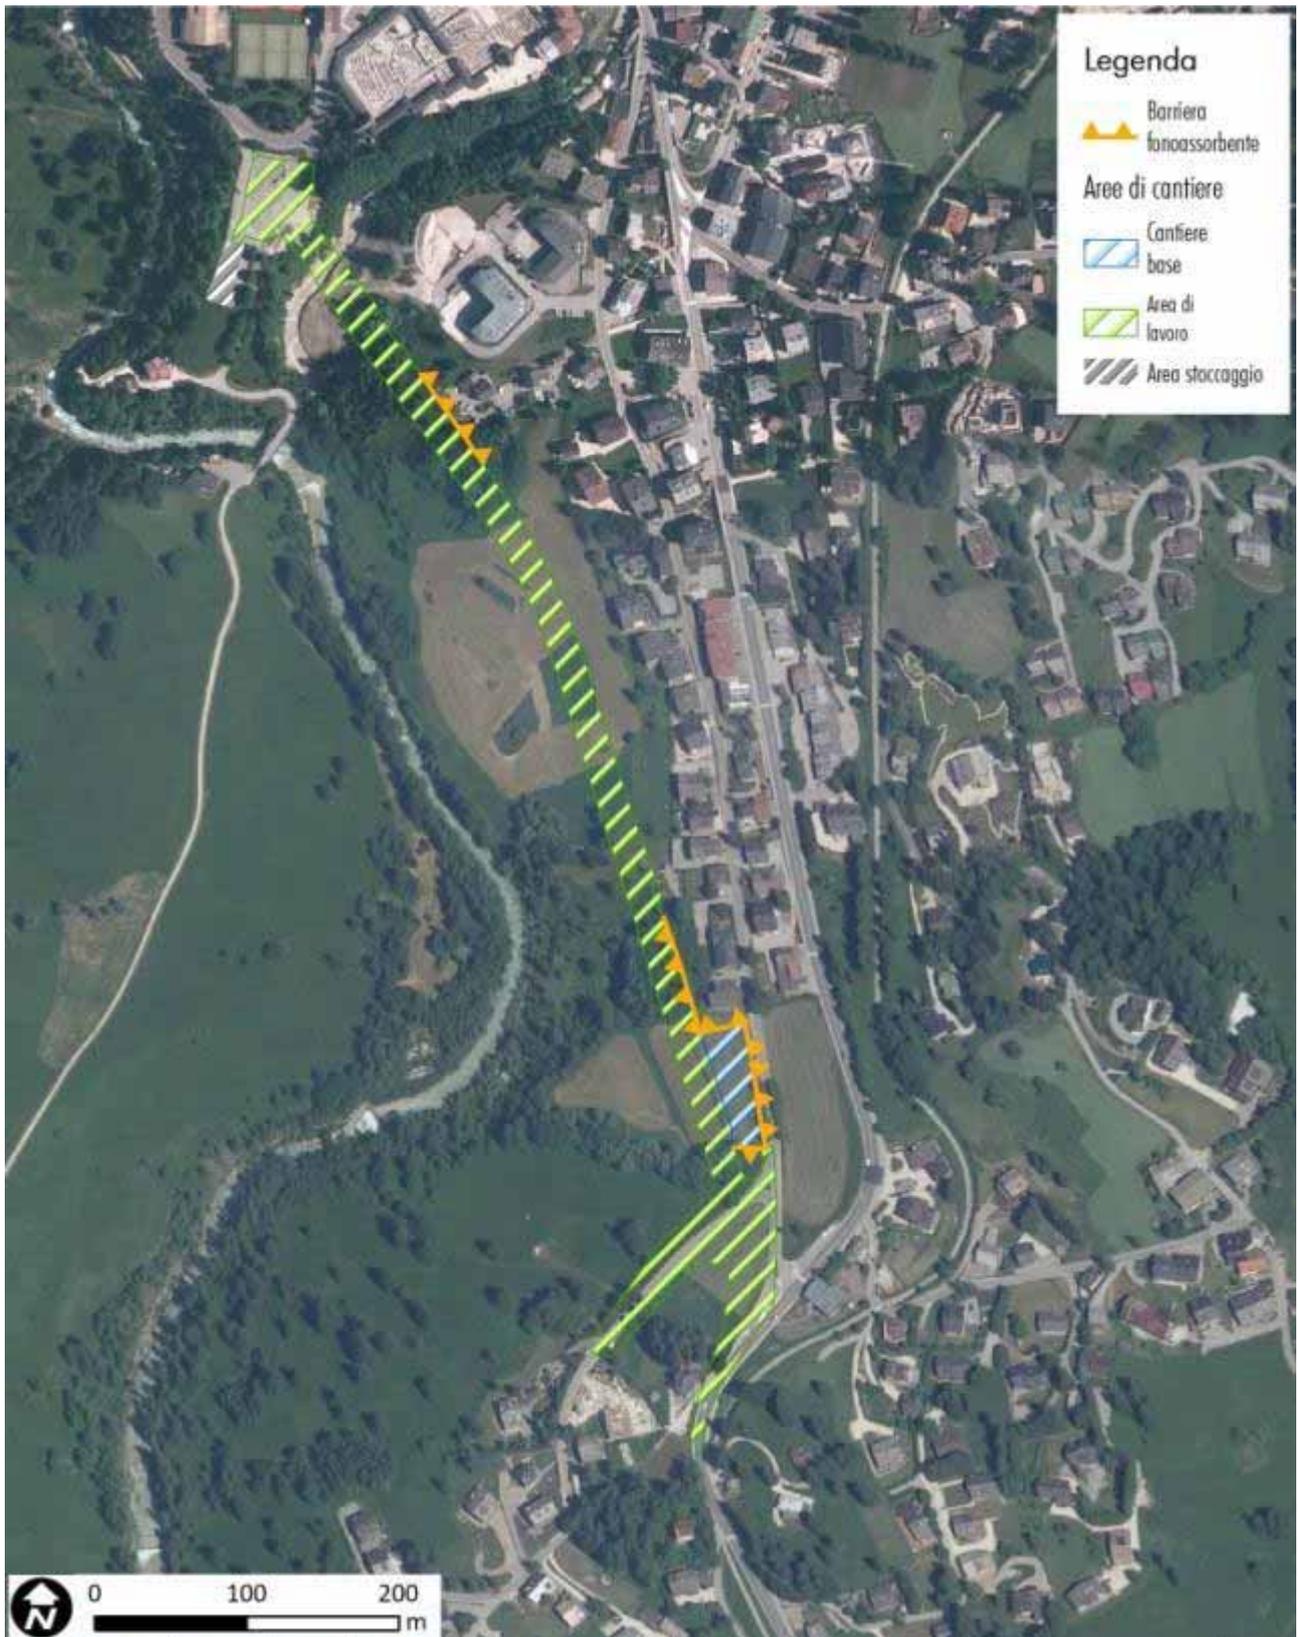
Ubicazione delle barriere fonoassorbenti nelle aree di cantiere.
